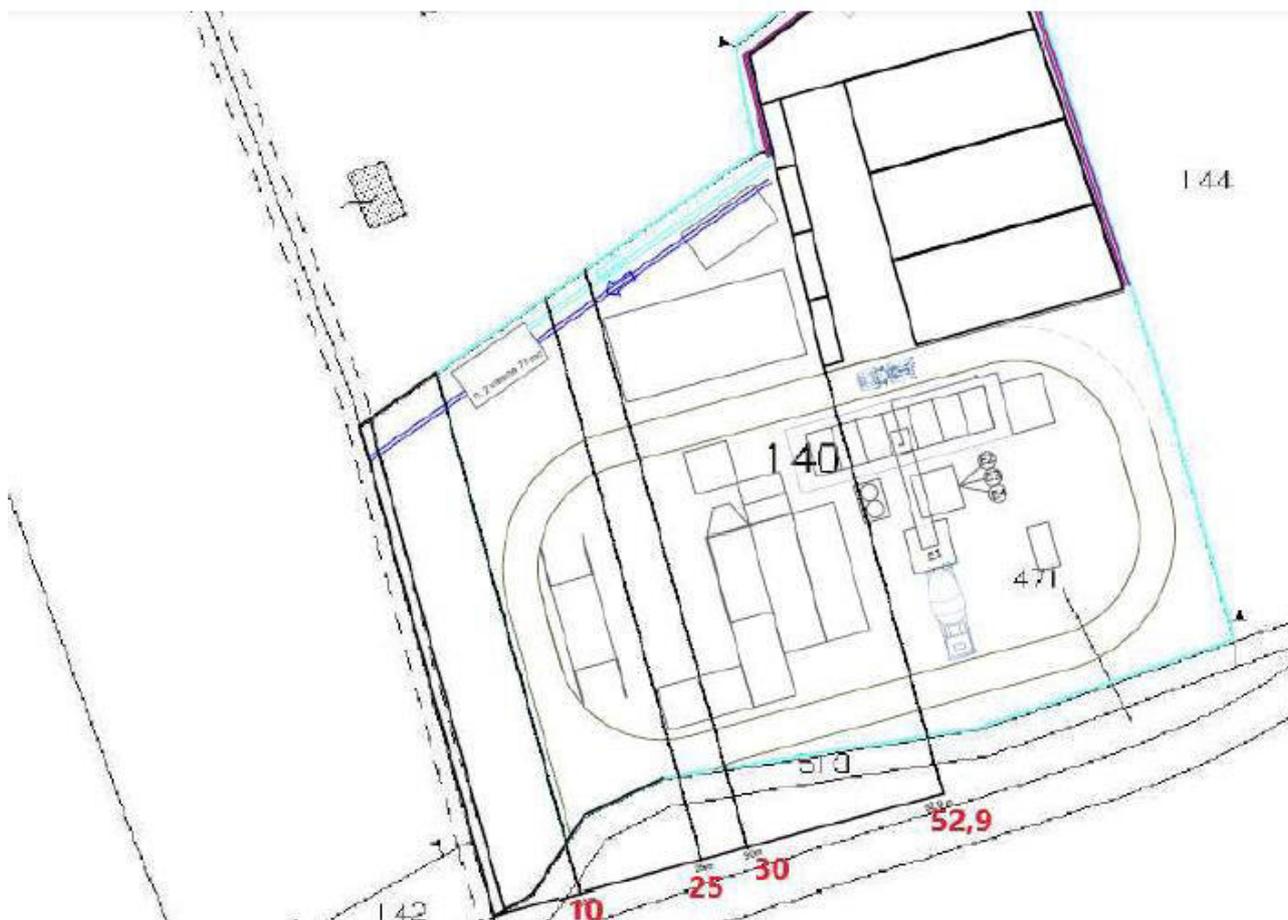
distanze dell'impianto rispetto al fosso Lupo
